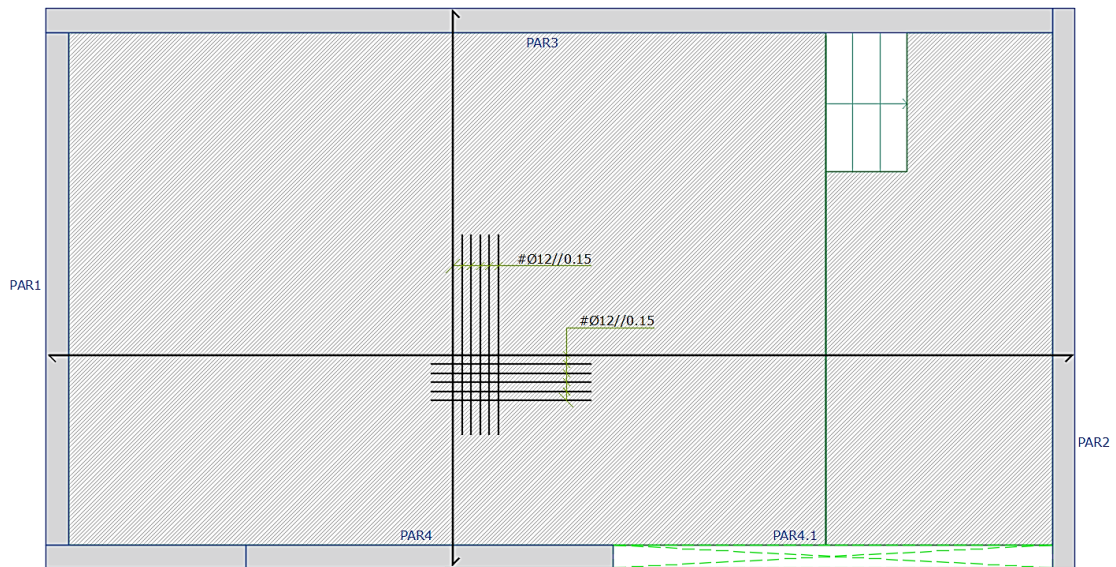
Planta malha de armaduras superiores em X e em Y
